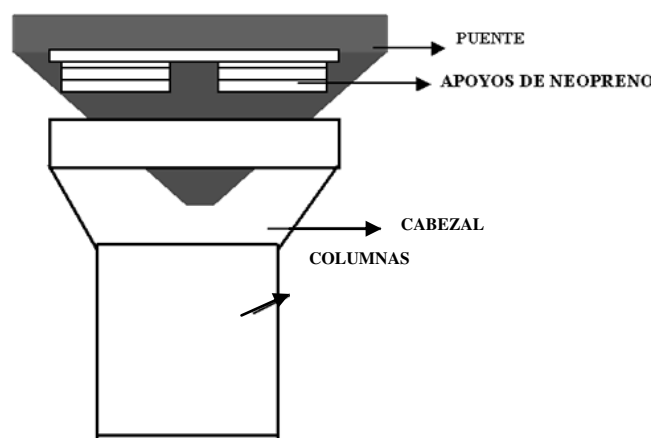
Apoyos de neoprenos en puentes (www.hormigoma.com).
